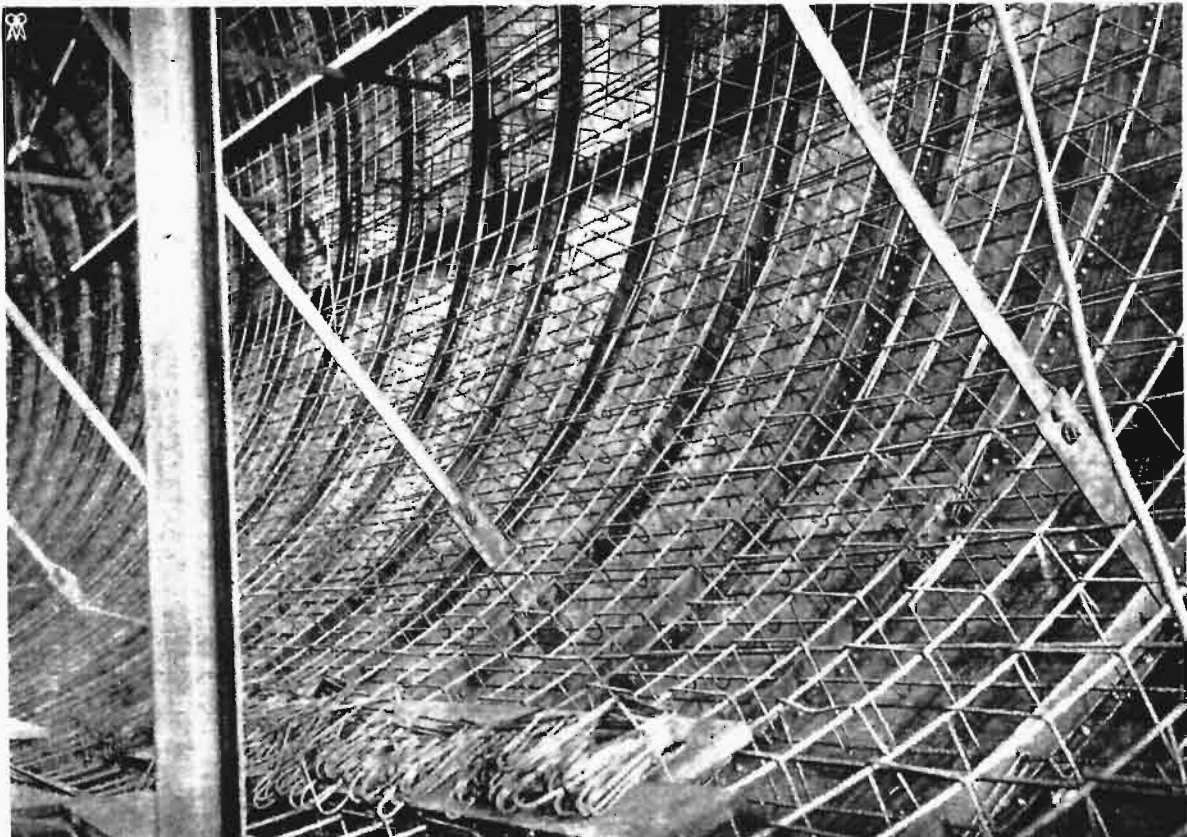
Zamykanie wylotów gotowej sekcji podwodnej przed jej betonowaniem.
